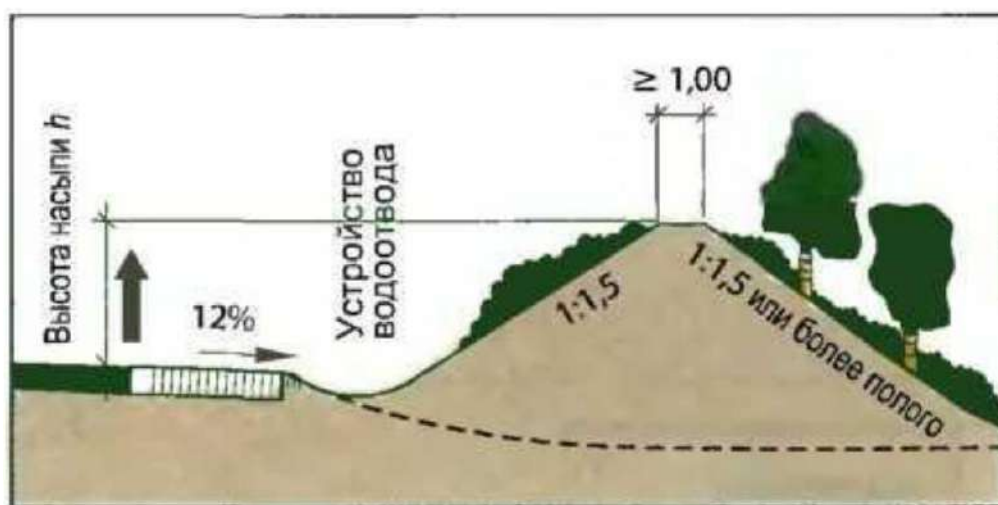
Схема шумозащитной насыпи с водоотводом и зелеными насаждениями
